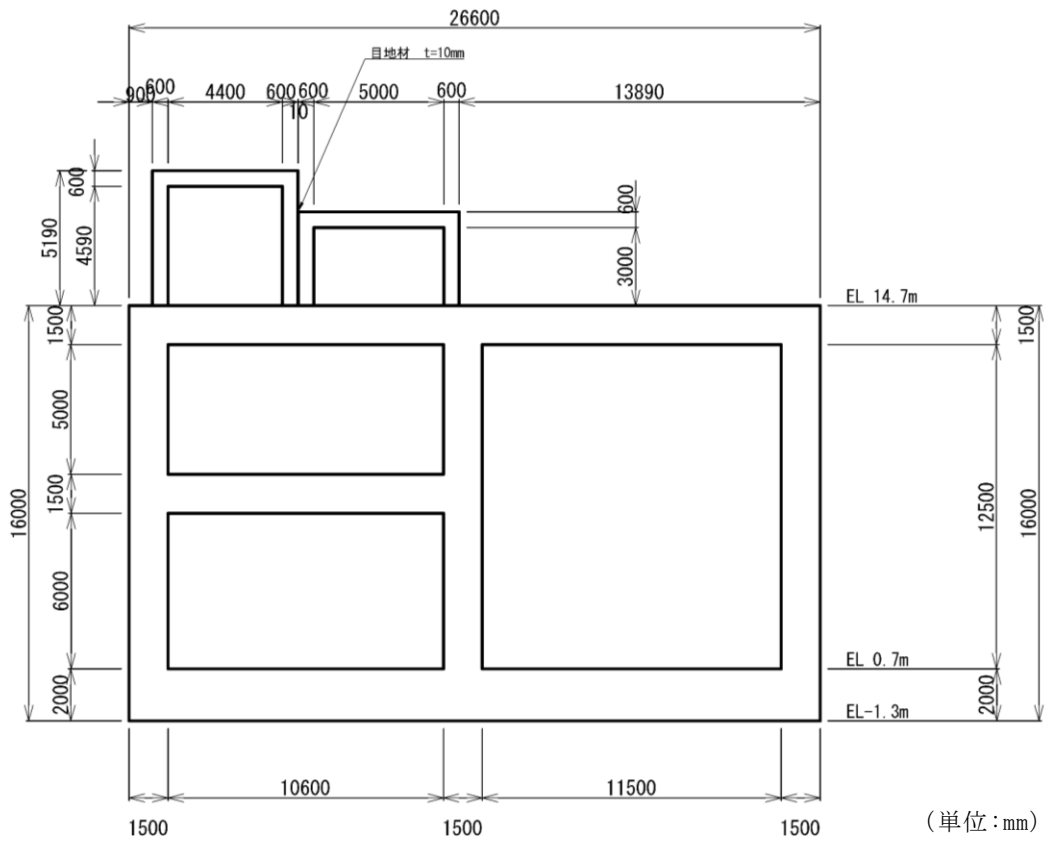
低圧原子炉代替注水ポンプ格納槽 断面図 (C-C 断面)
